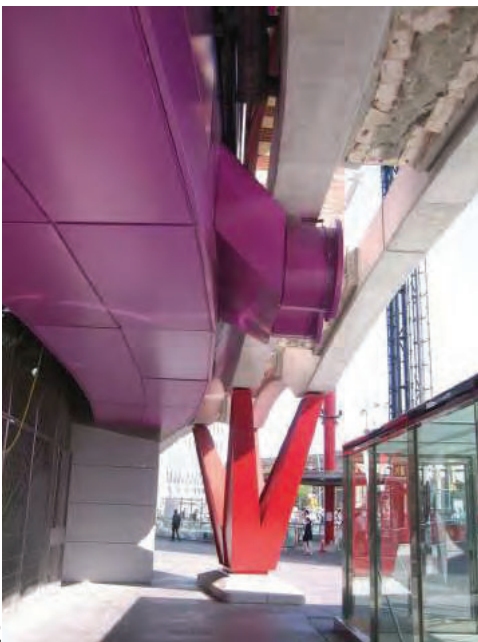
Fig. 1.30 imágenes de Wikiarquitectura
